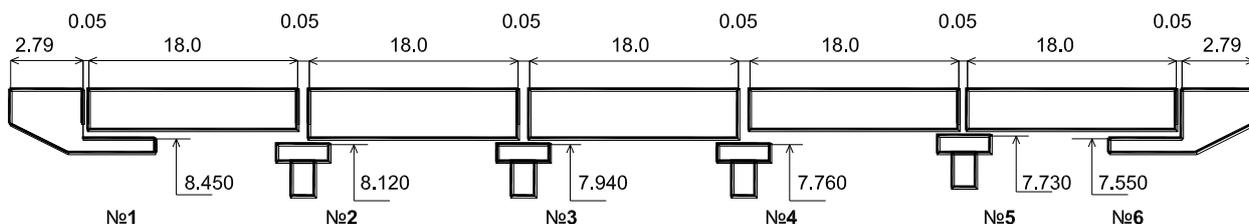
Схема определения отметок верха ригелей промежуточных опор и верха насадок устоев.
